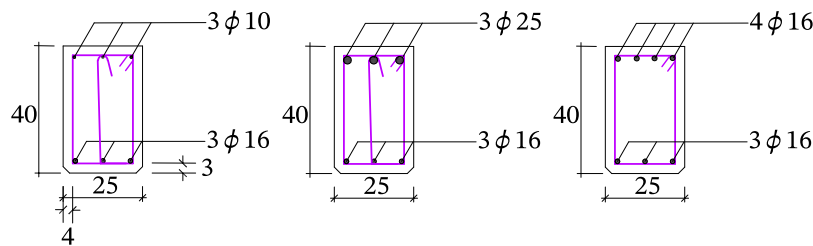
Sections des poutres transversales en travée, sur appuis et en rive.
